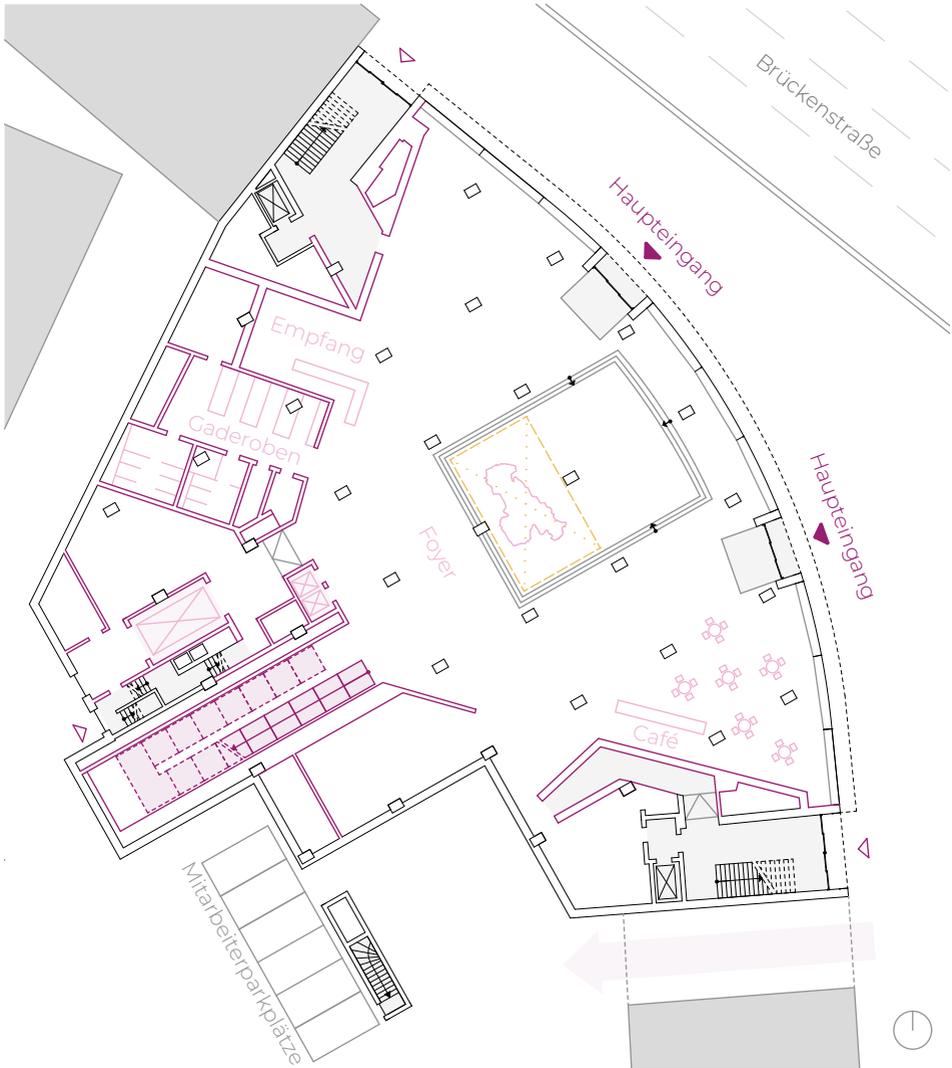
Grundriss Erdgeschoss 1:500
